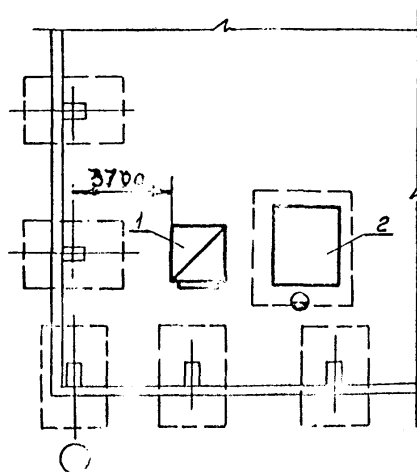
Схема расположения участка ковочных молотов с МПЧ 150-5000 кг с нагревательными камерными печами (верхнее или нижнее дымоудаление):
